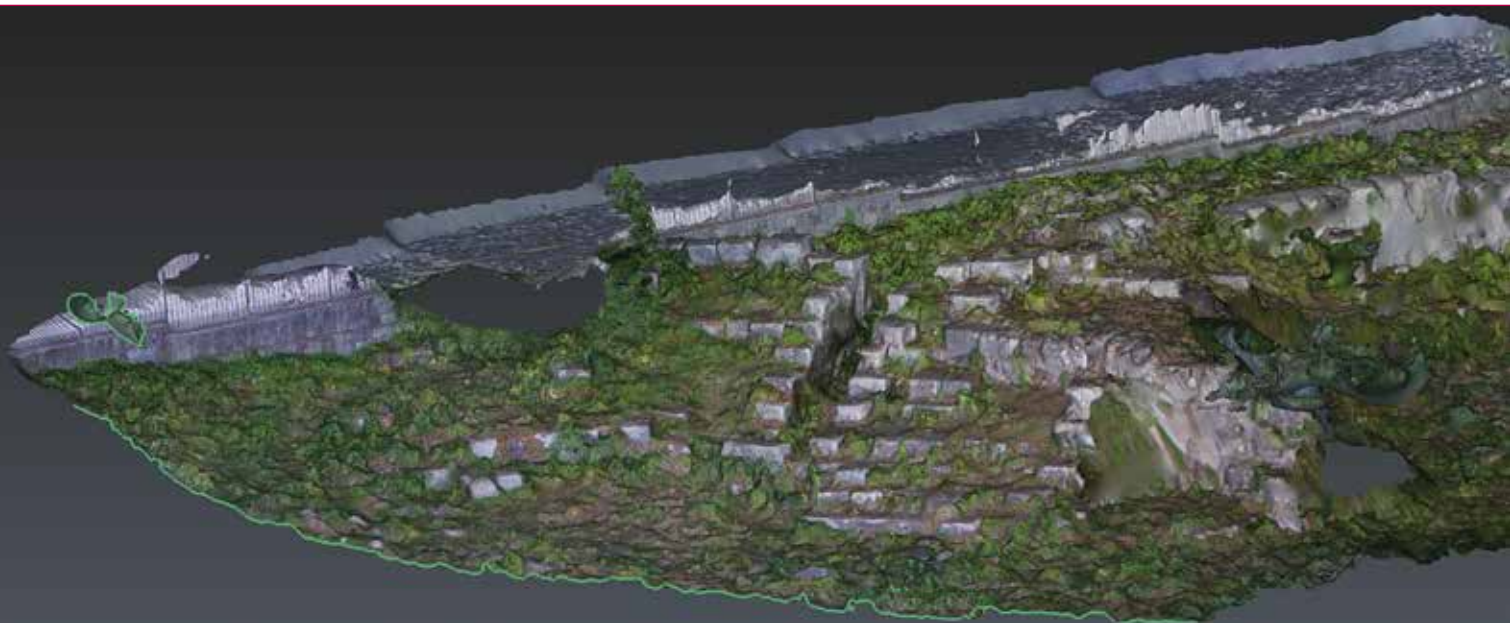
Sezione - prospetto elaborata con 3DReshaper.
